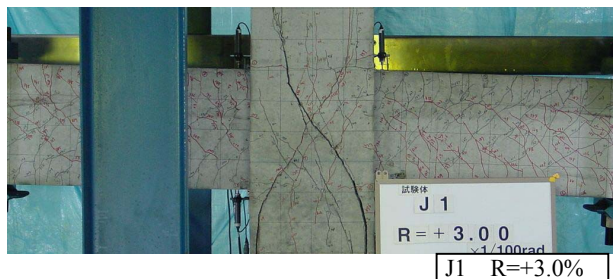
架構実験 ひび割れ発生状況(最大耐力時)
